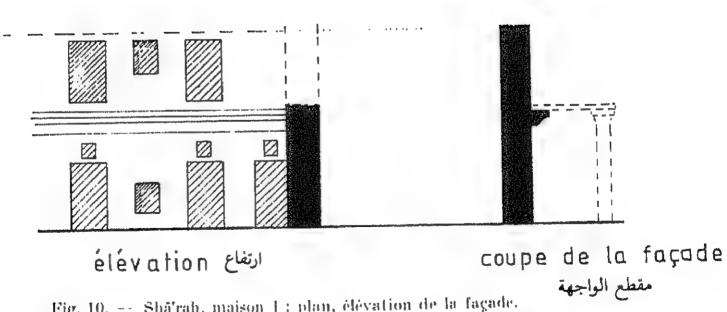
Shā'rah, maison 1 : plan, ēlēvation de la façade. عطط الشكل رقم ١٠ ـ «شعارة» البيت رقم ١ بيانات وارتفاع الواجهة ـ مخطط
